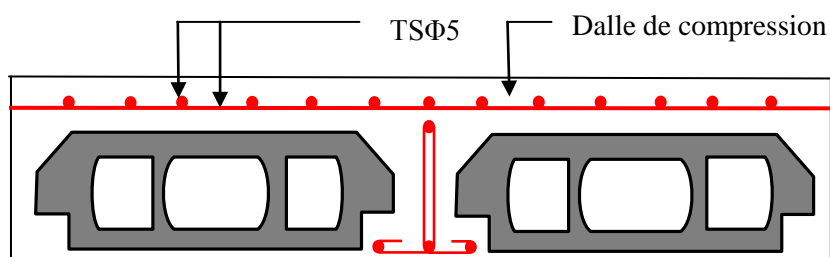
Schéma de ferrailage de la dalle de compression.
